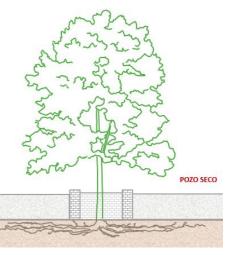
Construcción de un pozo seco. Fuente: Tecnigral.
